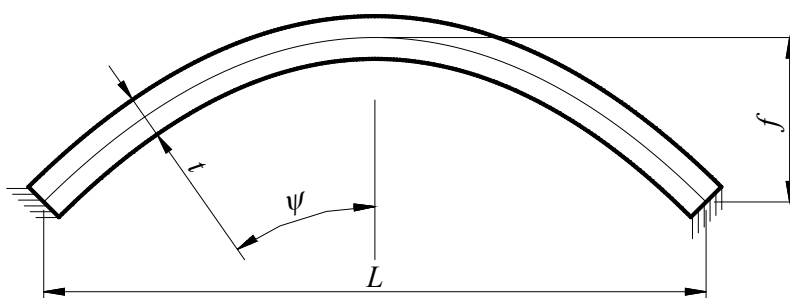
Arco parabólico, perfeitamente encastrado, de espessura constante (adaptado de [29]).
